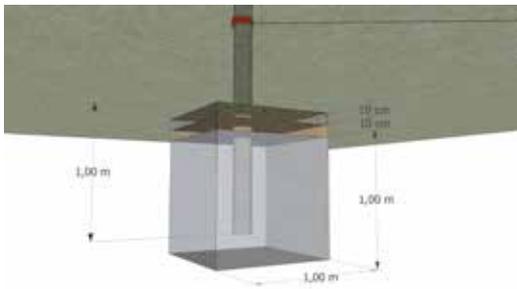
Betonfundament mit einer für eine durchschnittliche
